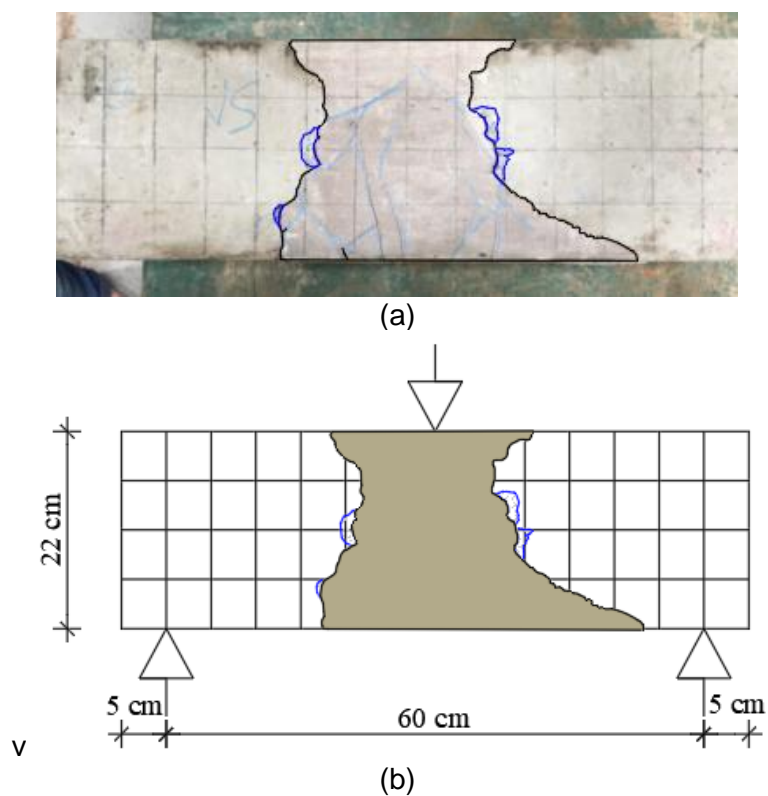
Mapeamento de fissuras da viga V4_AAC20 após a reconstituição.
